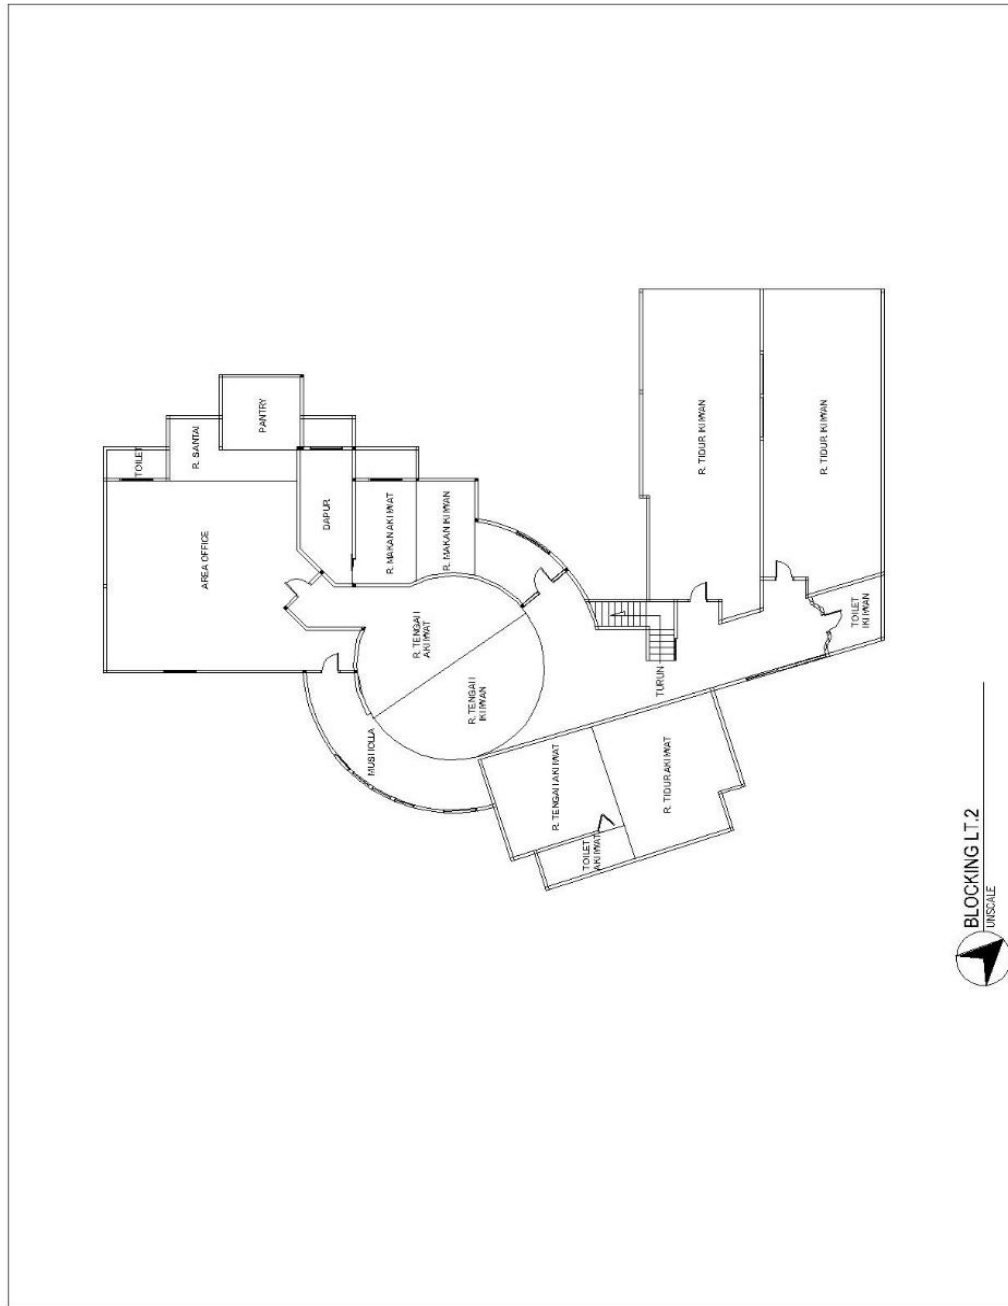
Zoning Mualaf Center Lantai 2
